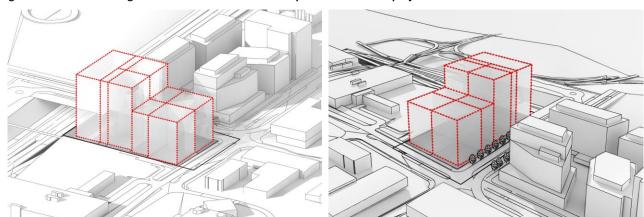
vue en 3D des gabarits constructibles maximum pour constructions projetées
